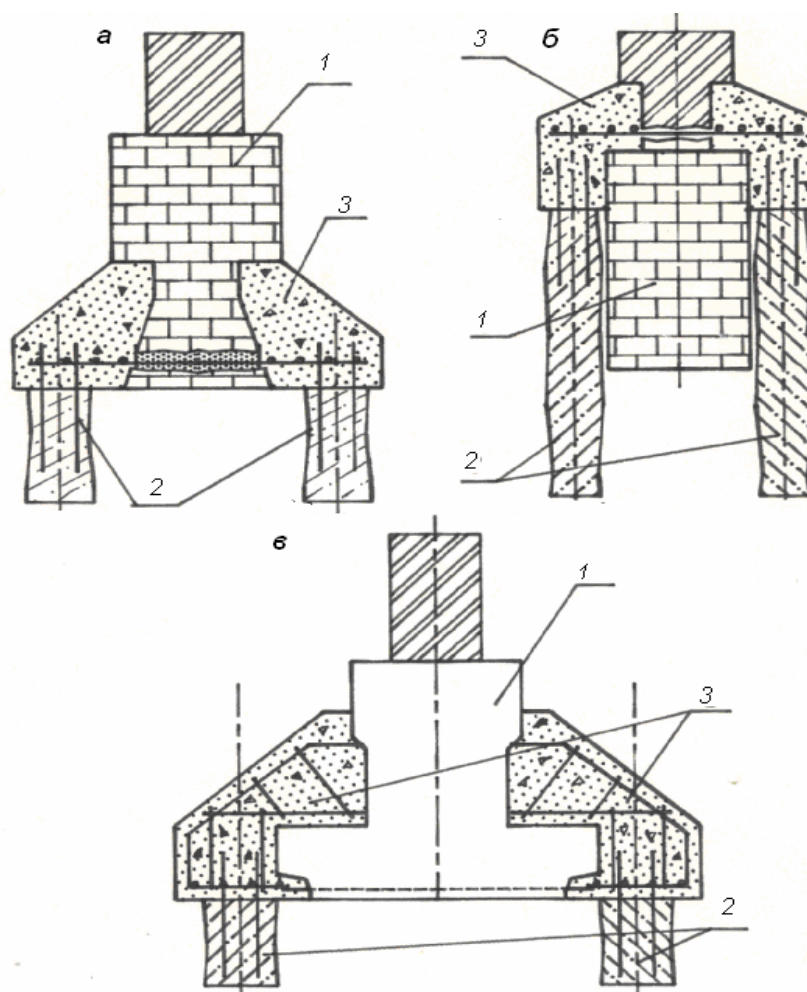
Усиление фундаментов сваями с монолитным ростверком:
